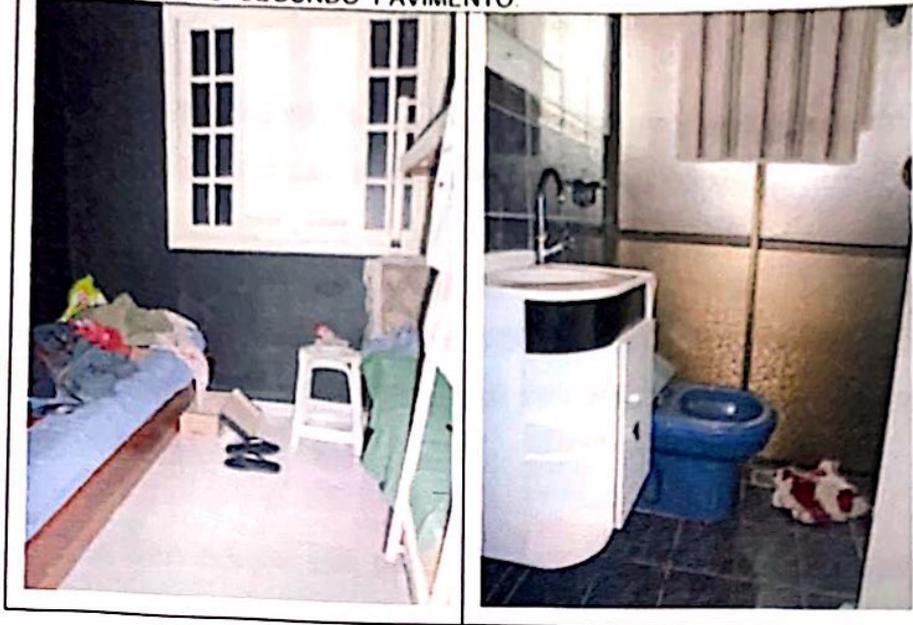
DETALHES DA TERCEIRA SUÍTE, SITA NA PARTE POSTERIOR DO SEGUNDO PAVIMENTO.
